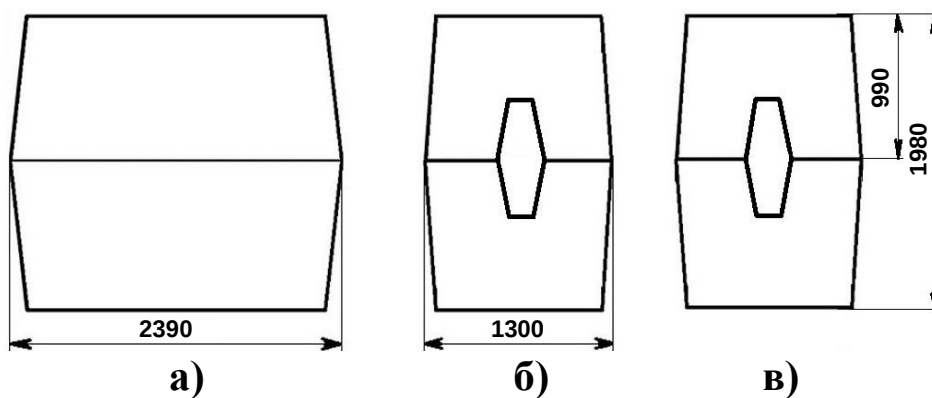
Габаритные размеры колодца «ККСр-4-10»:
